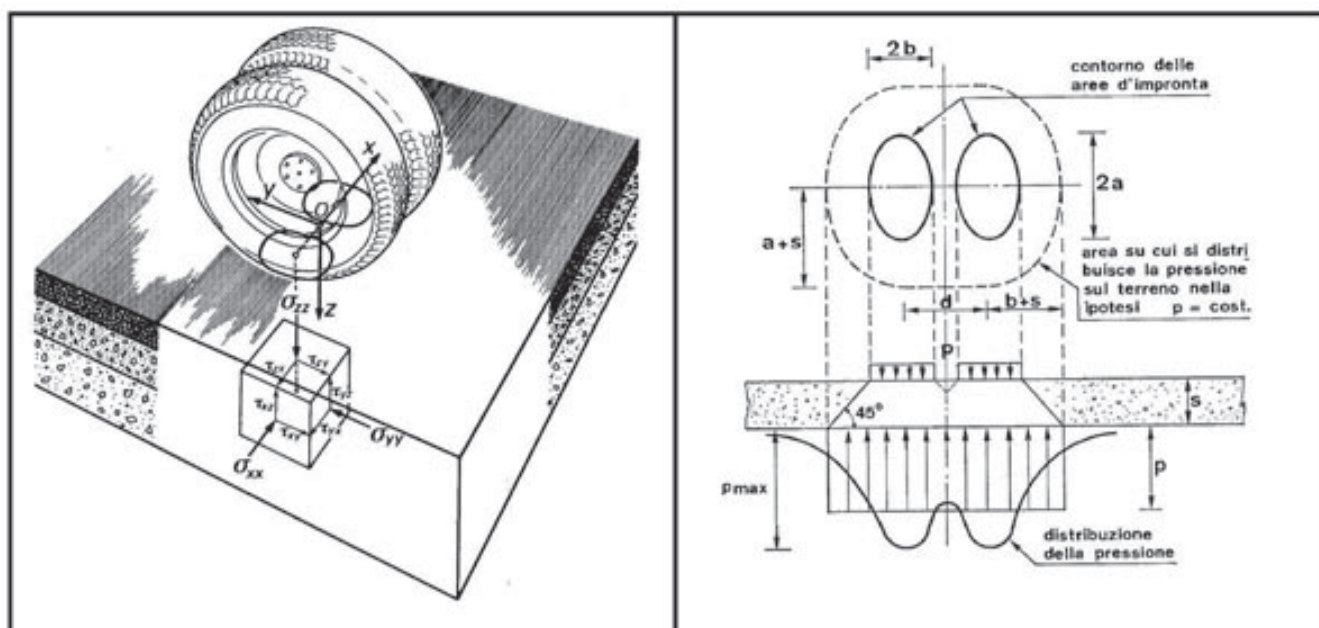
distribuzione dei carichi e delle pressioni in una pavimentazione
